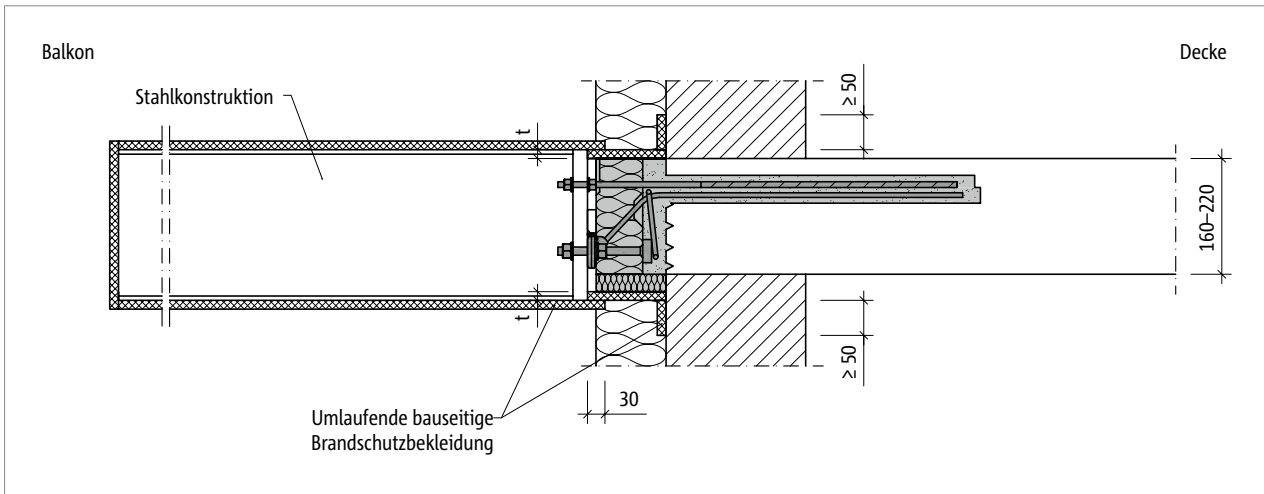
Schöck Isokorb® RT Typ SK: Bauseitige Brandschutzbekleidung RT Typ SK und Stahlkonstruktion; Schnitt
